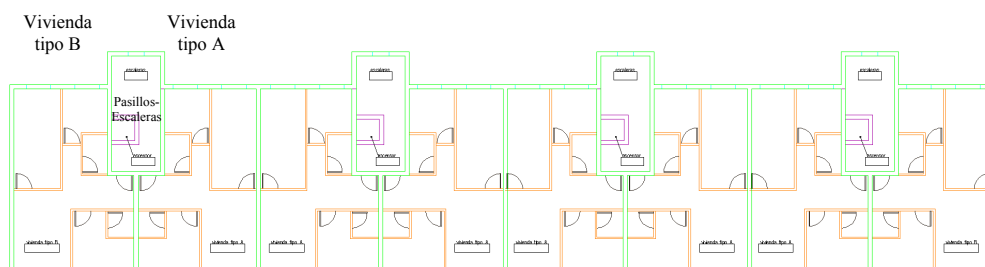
Zonificación de las plantas 1-5 del bloque de viviendas
